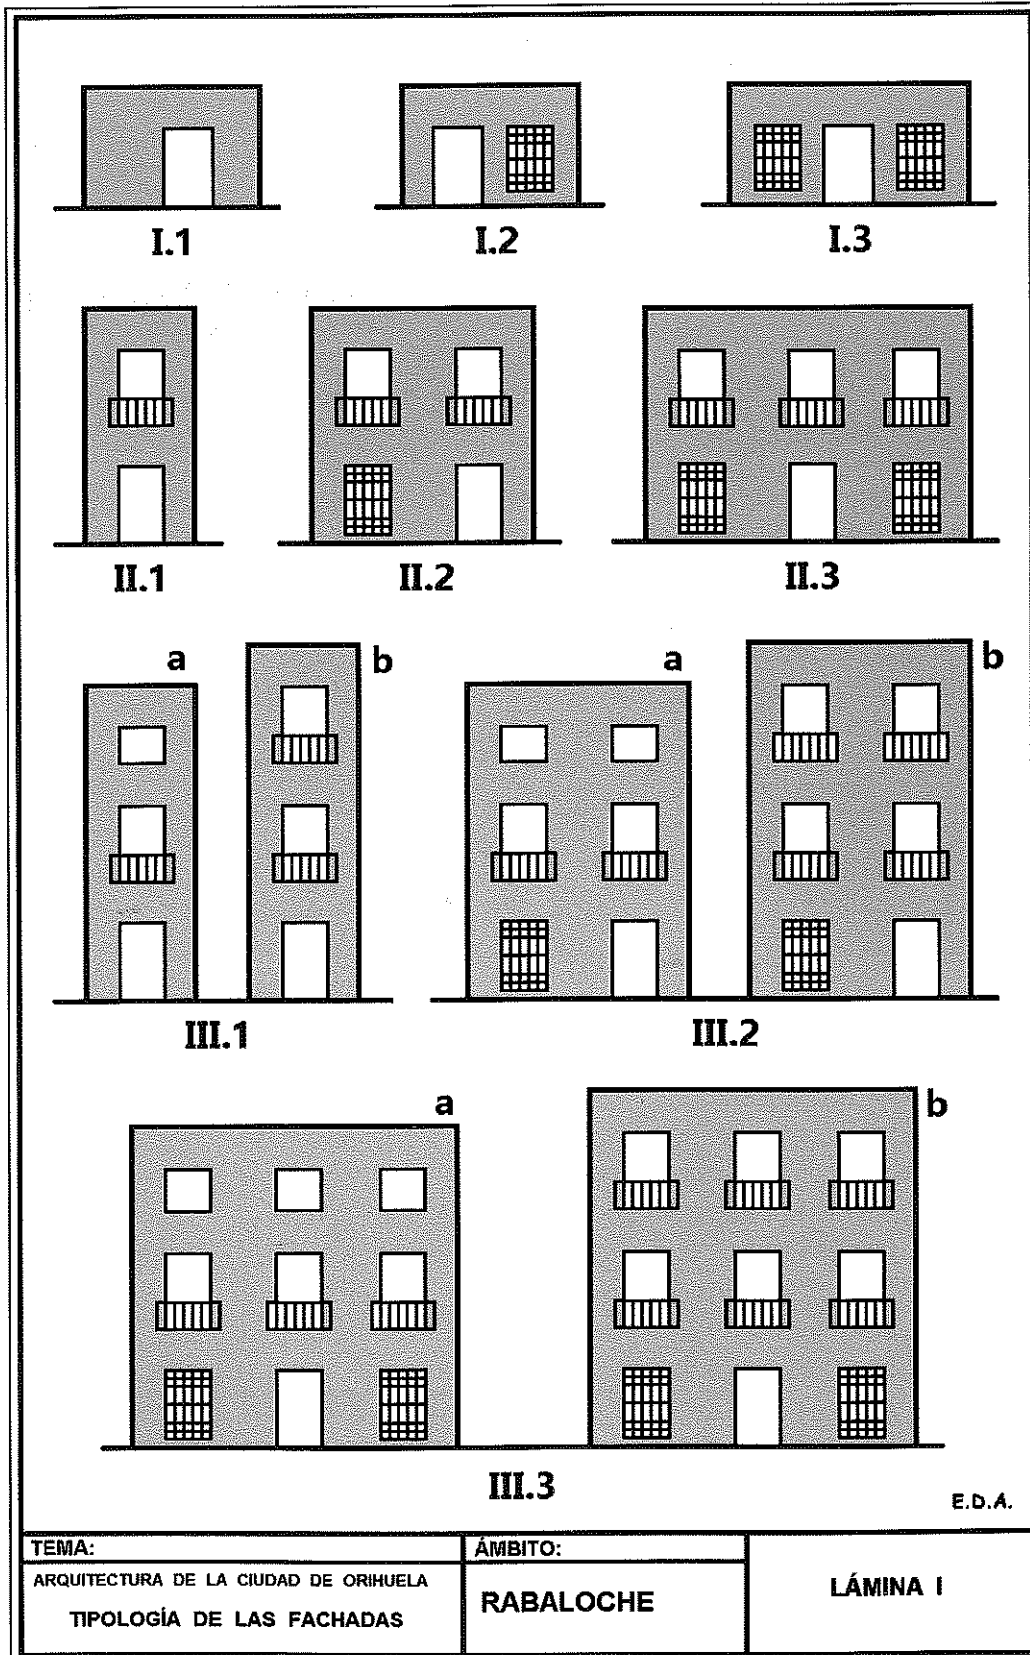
Tipología de las fachadas del Rabaloche (elaboración propia)
